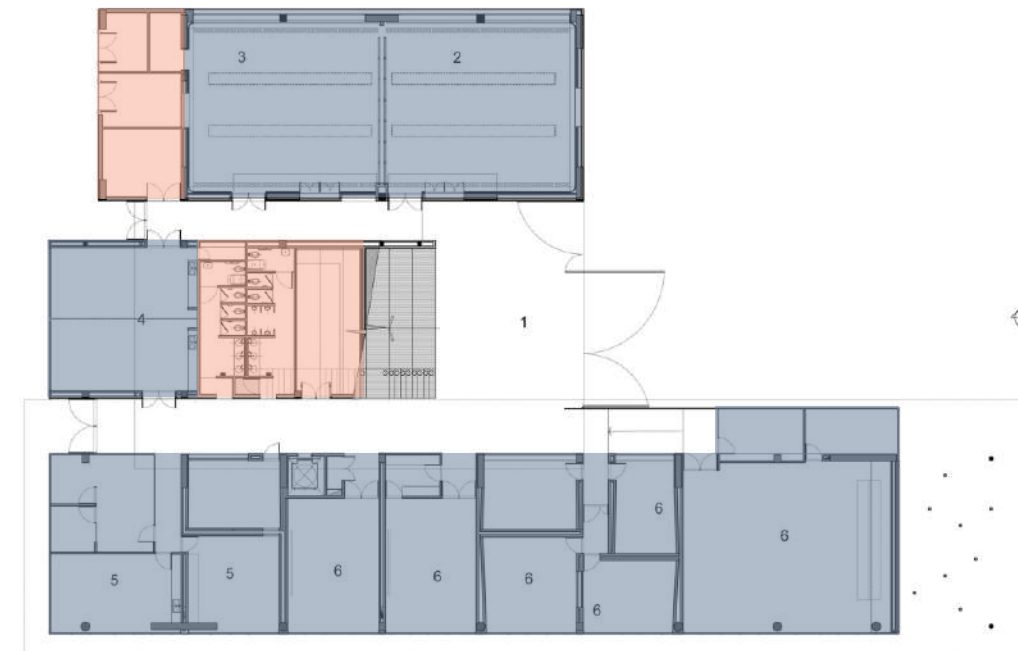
Planta Baixa Térreo - Fonte: Archdaily, 2014
